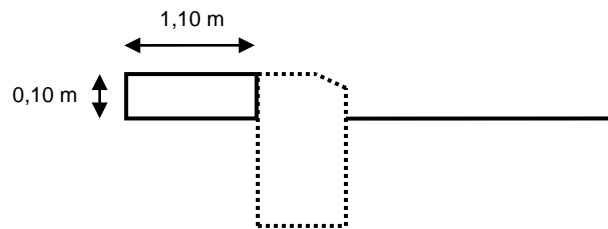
, Plano visto en planta de la vía, Fuente Fénix Construcciones S.A.
